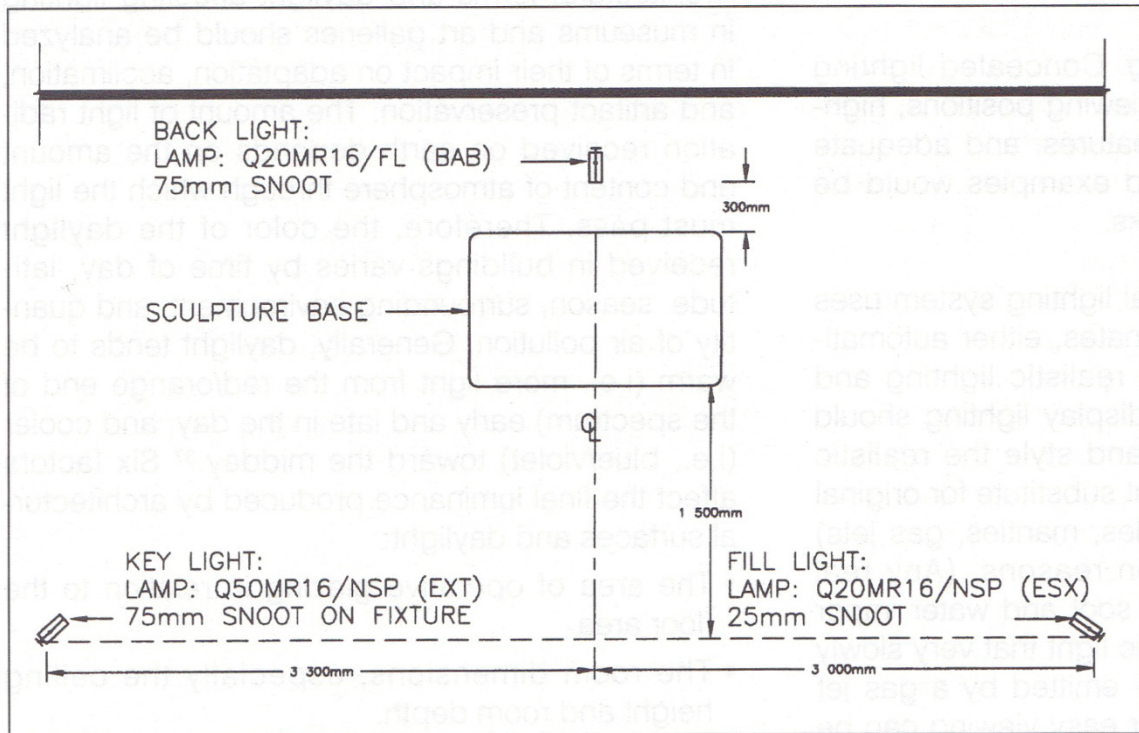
Vista em planta de iluminação para objectos tridimensionais [36]
